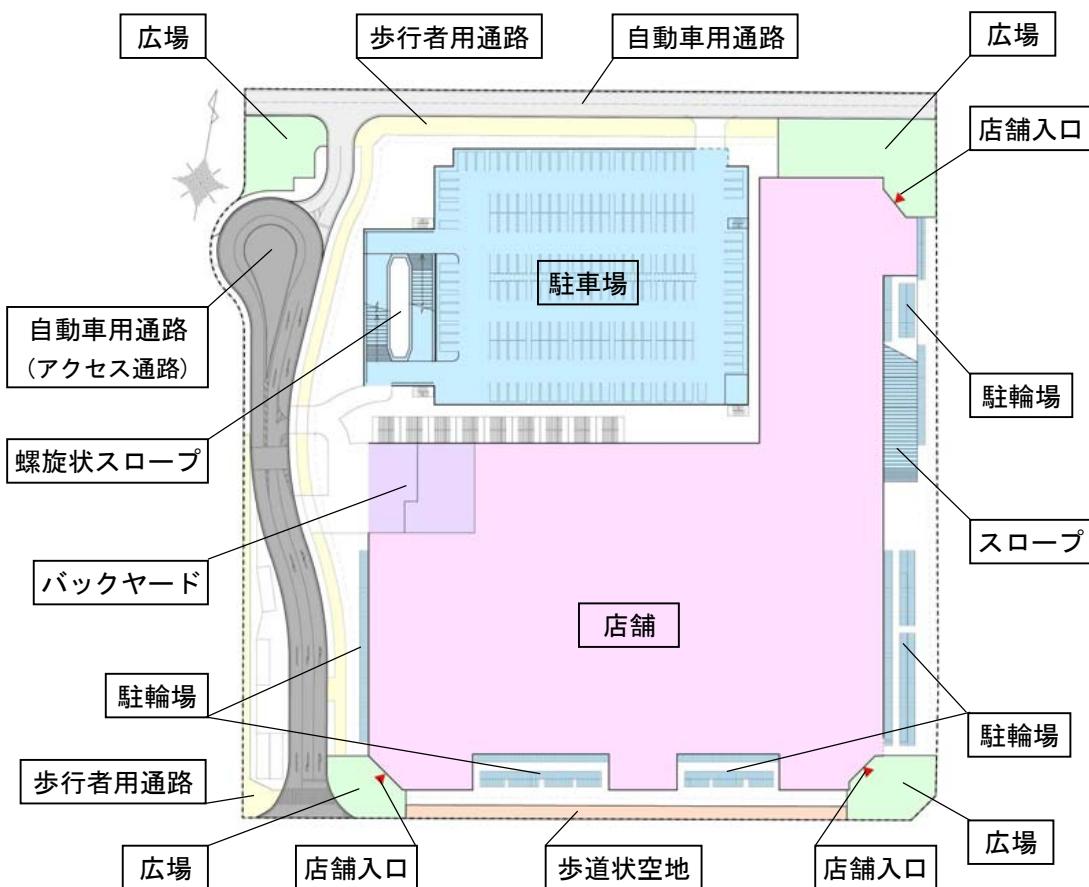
(1) 各階平面図(商業棟 1 階, 駐車場棟 1 階)
